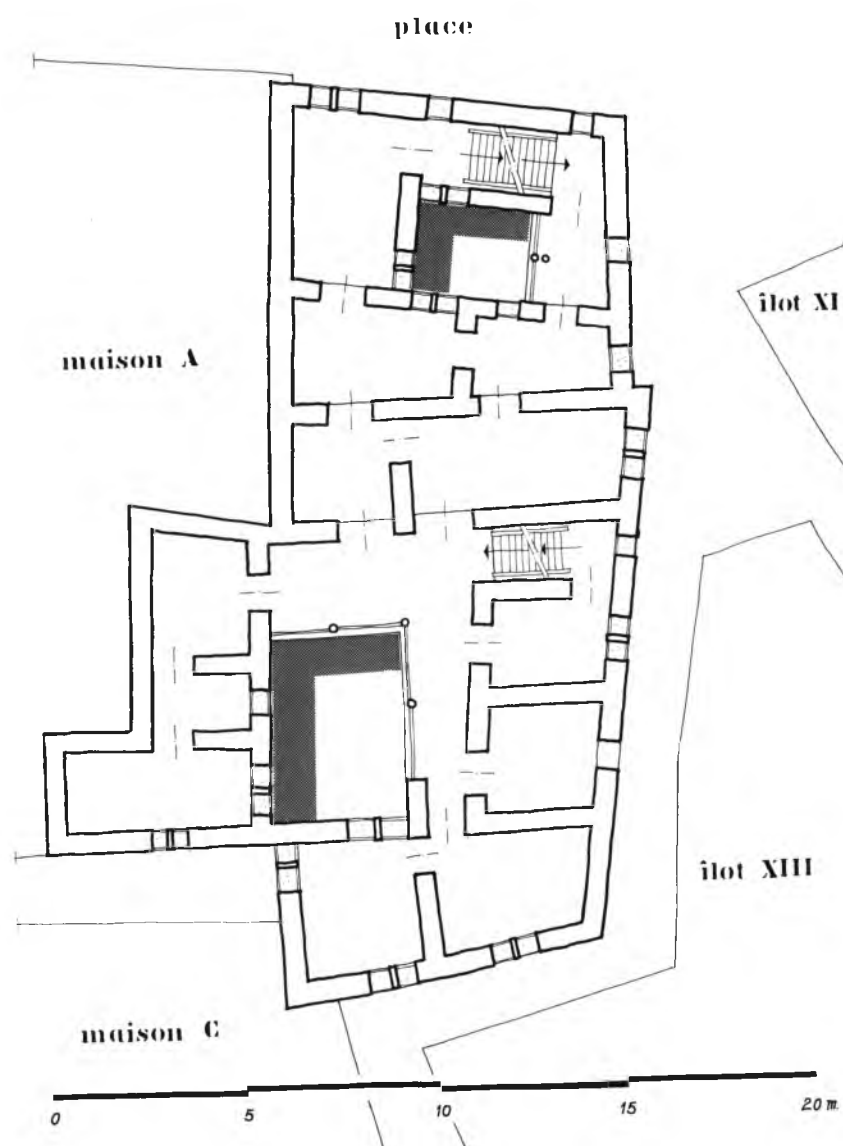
Îlot X : Maison B, plan restitué du premier étage.
